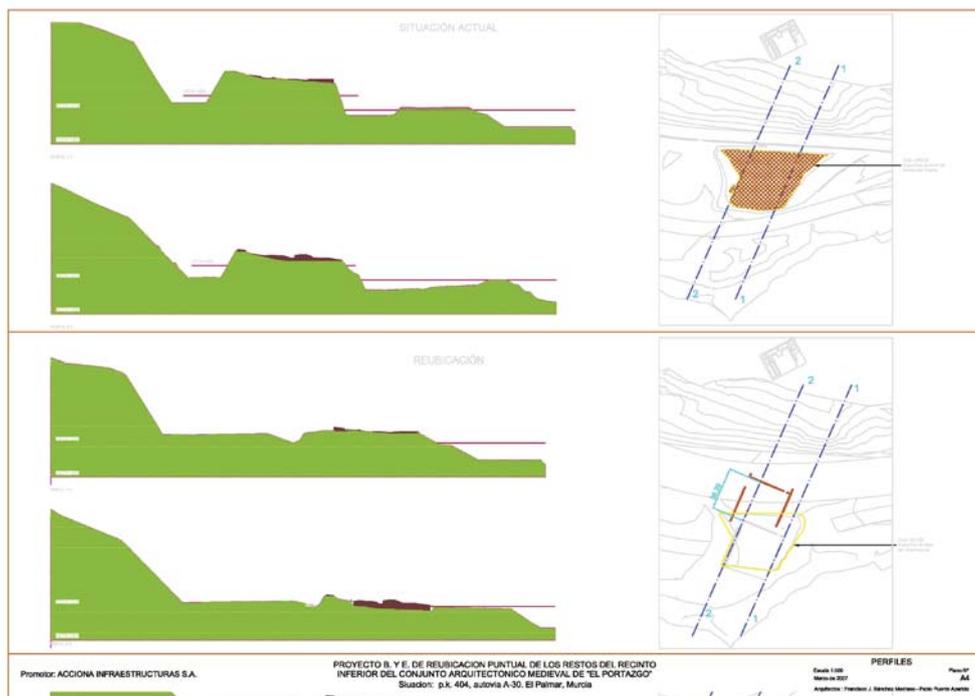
Secciones y plantas que explican el movimiento de traslado de los restos. (2005, Fuente: Proyecto)
